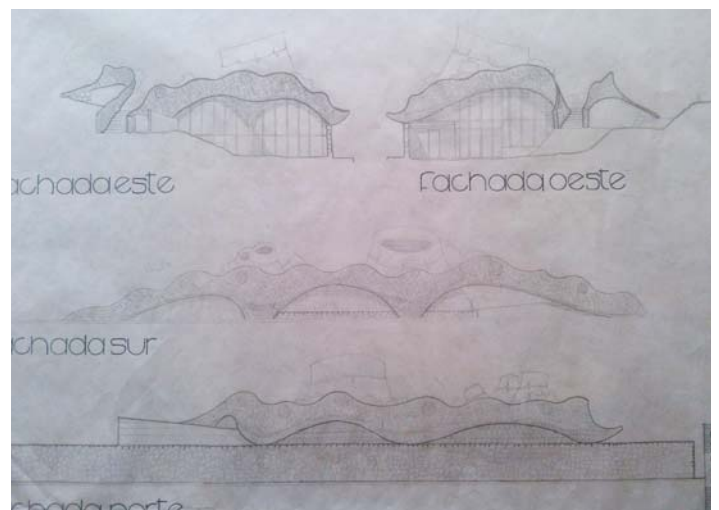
Fachadas del proyecto con las bóvedas incrustándose dentro de la cubierta.
